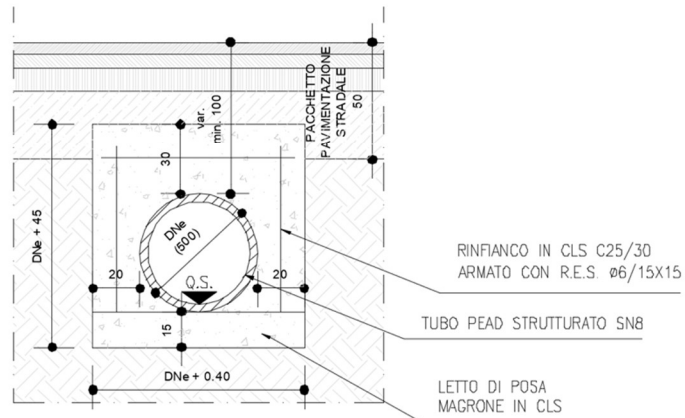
Tipico posa condotte con altezza di ricoprimento inferiore al metro
